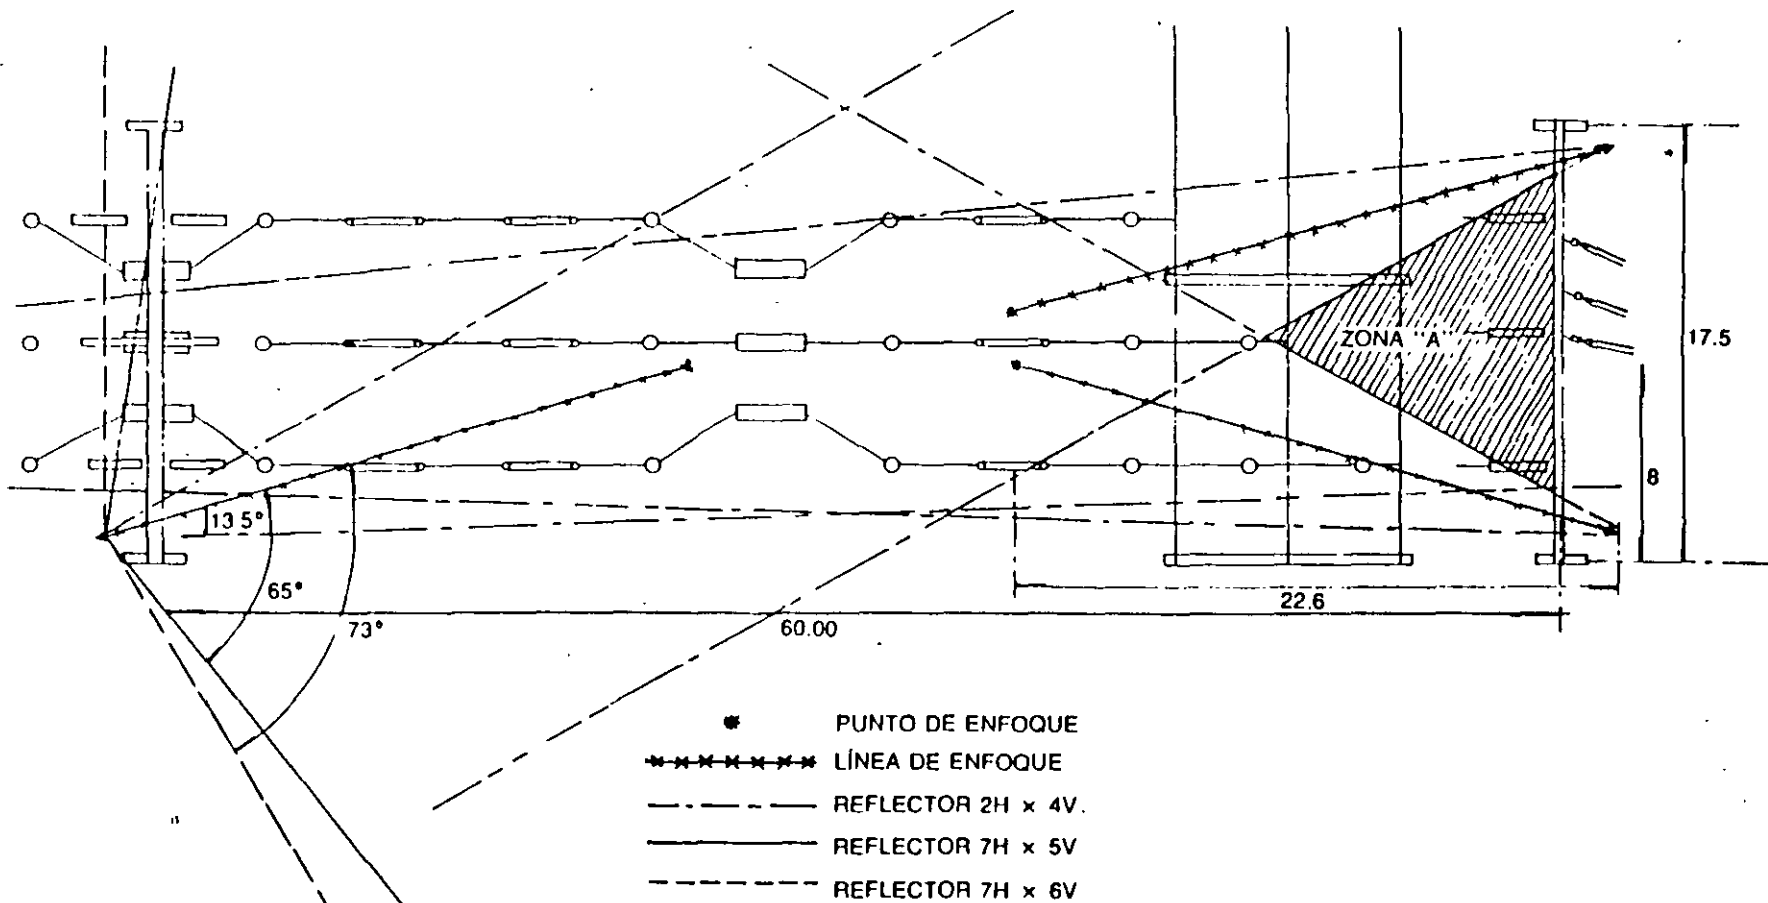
Vista de planta de los haces horizontales de los tres reflectores (1/2 módulo de 230 kV)
